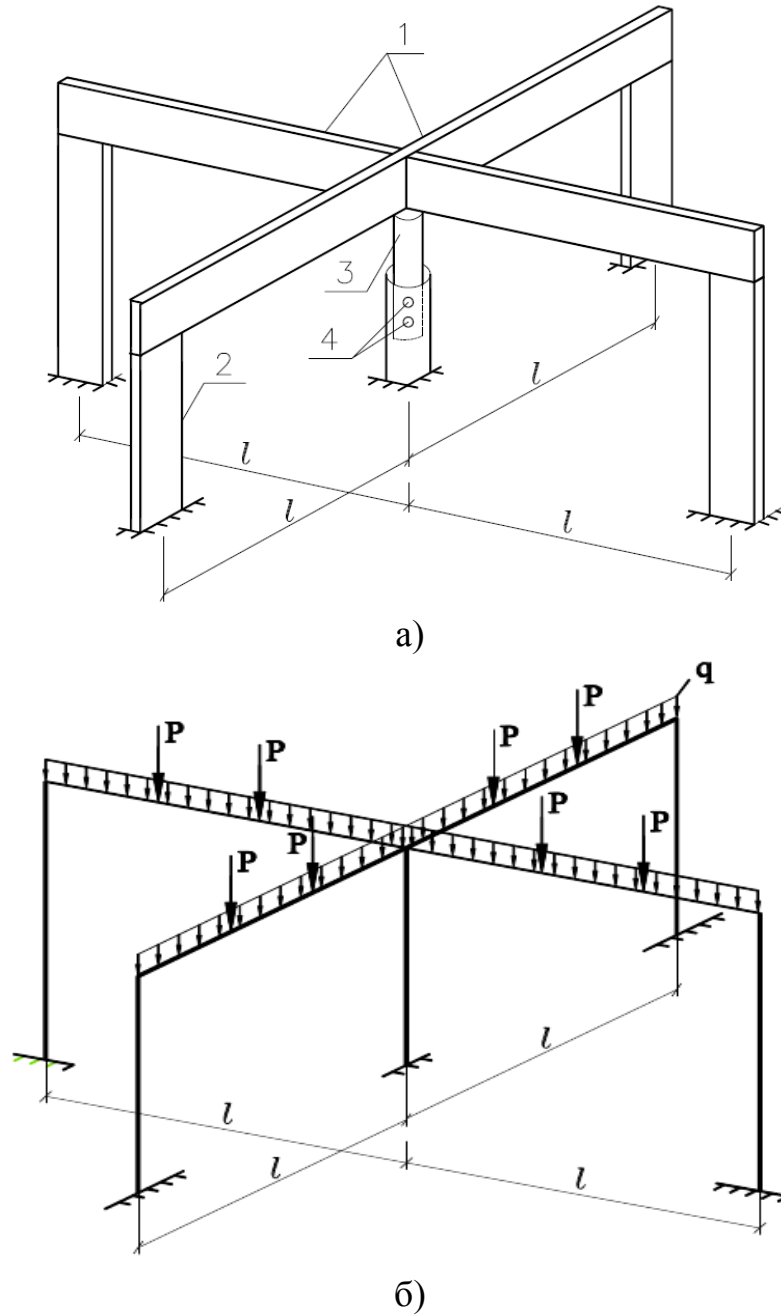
Опытный характерный фрагмент (а) и расчетная схема (б) железобетонного каркаса многоэтажного здания: 1 – ригель; 2 – стойка; 3 – телескопическая стойка; 4 – бетонная шпонка
